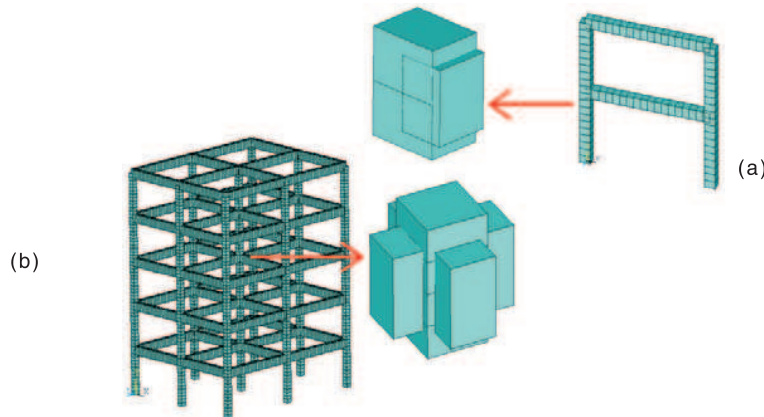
(a) Conexión de concreto pórtico plano, (b) Conexión de concreto pórtico tridimensional
